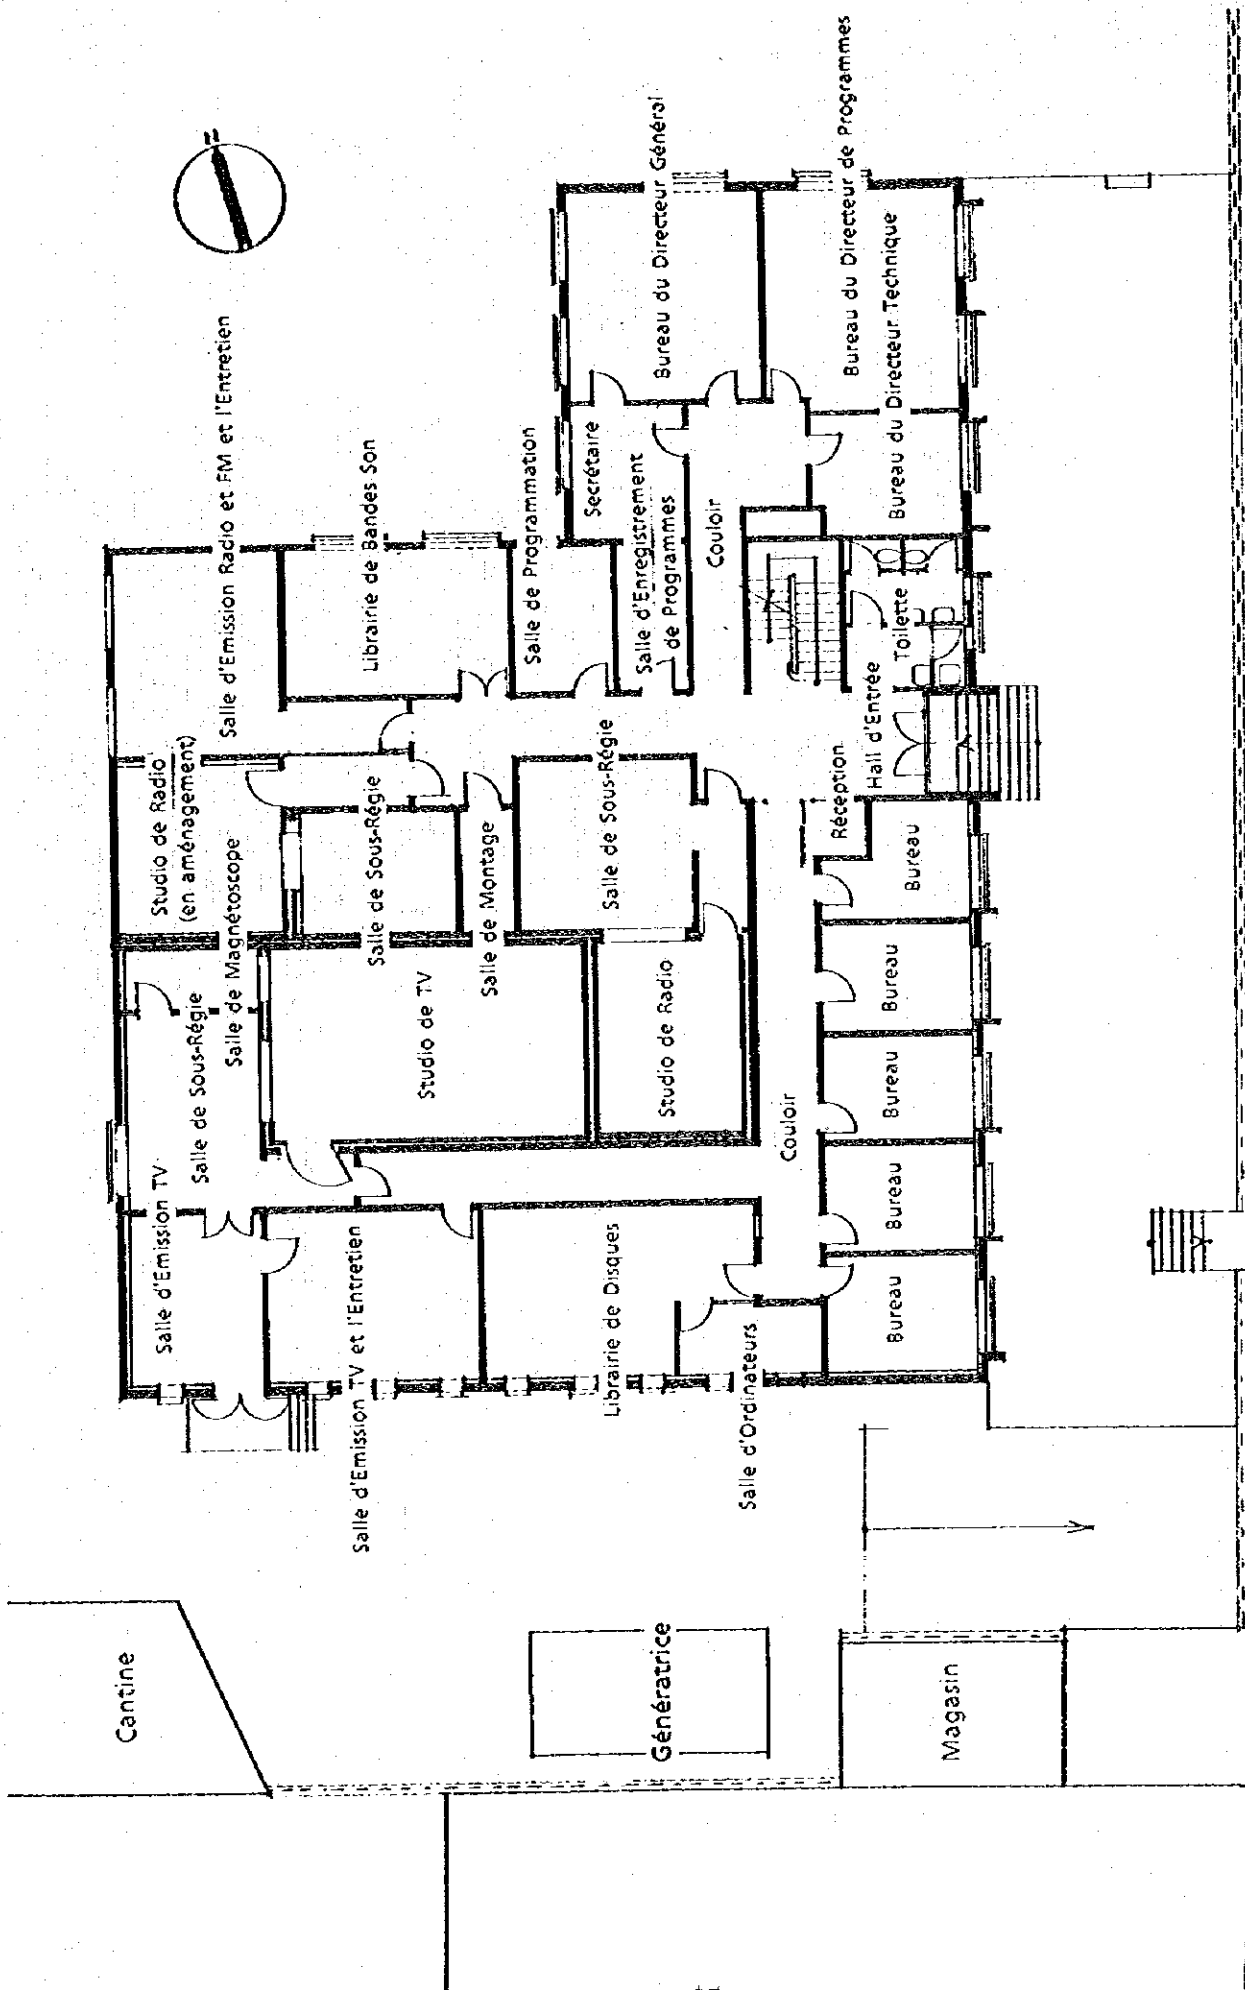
PLAN DU PREMIER ÉTAGE DU BATIMENT EXISTANT
